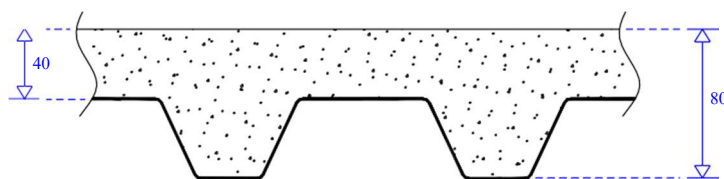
Espessuras mínimas [mm] da secção transversal de uma laje mista sem funções de contraventamento
